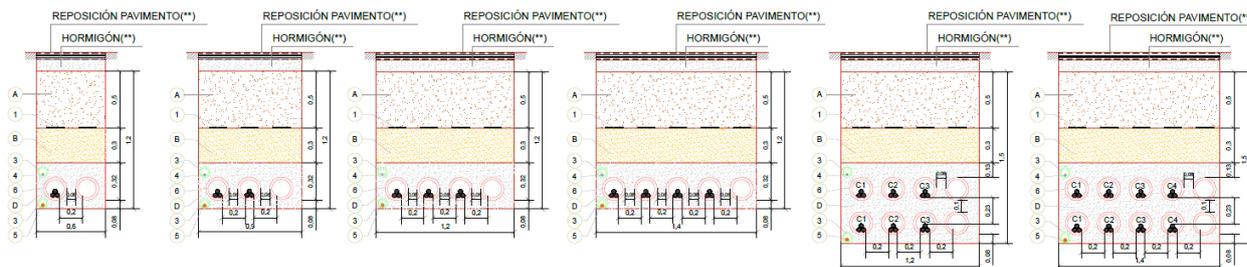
zanjas tipo conductor entubado bajo calzada o acera en zona urbana
